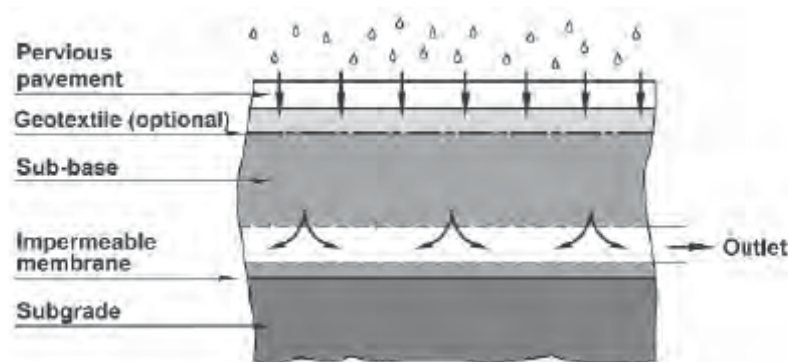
Pavimento poroso Tipo C sem nenhuma infiltração e só usando drenos
